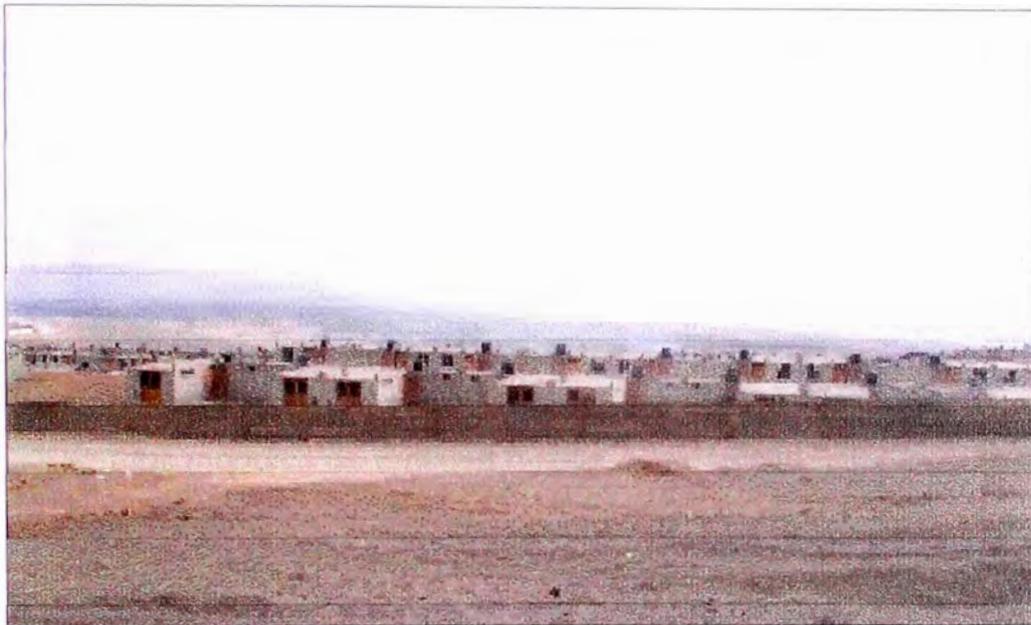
Otra vista de las viviendas del Programa Techo Propio. En la fotografía se puede apreciar la construcción a base de concreto armado y la distribución de las áreas que la integran: sala-comedor, cocina, baño. La vivienda de concreto armado la podemos apreciar en esta fotografía.
